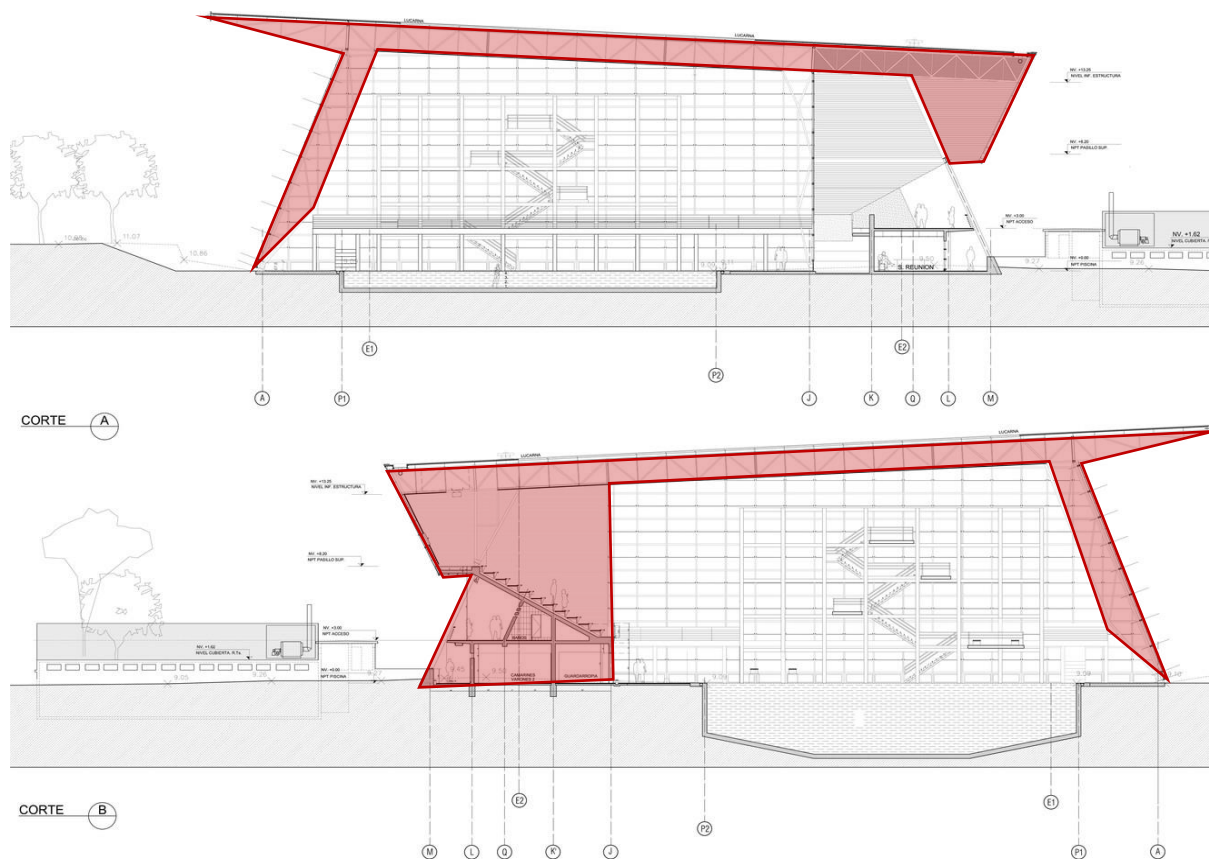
Estructura del centro acuático. (Fuente: Centro Acuático Estadio Nacional <https://www.archdaily.pe>)
